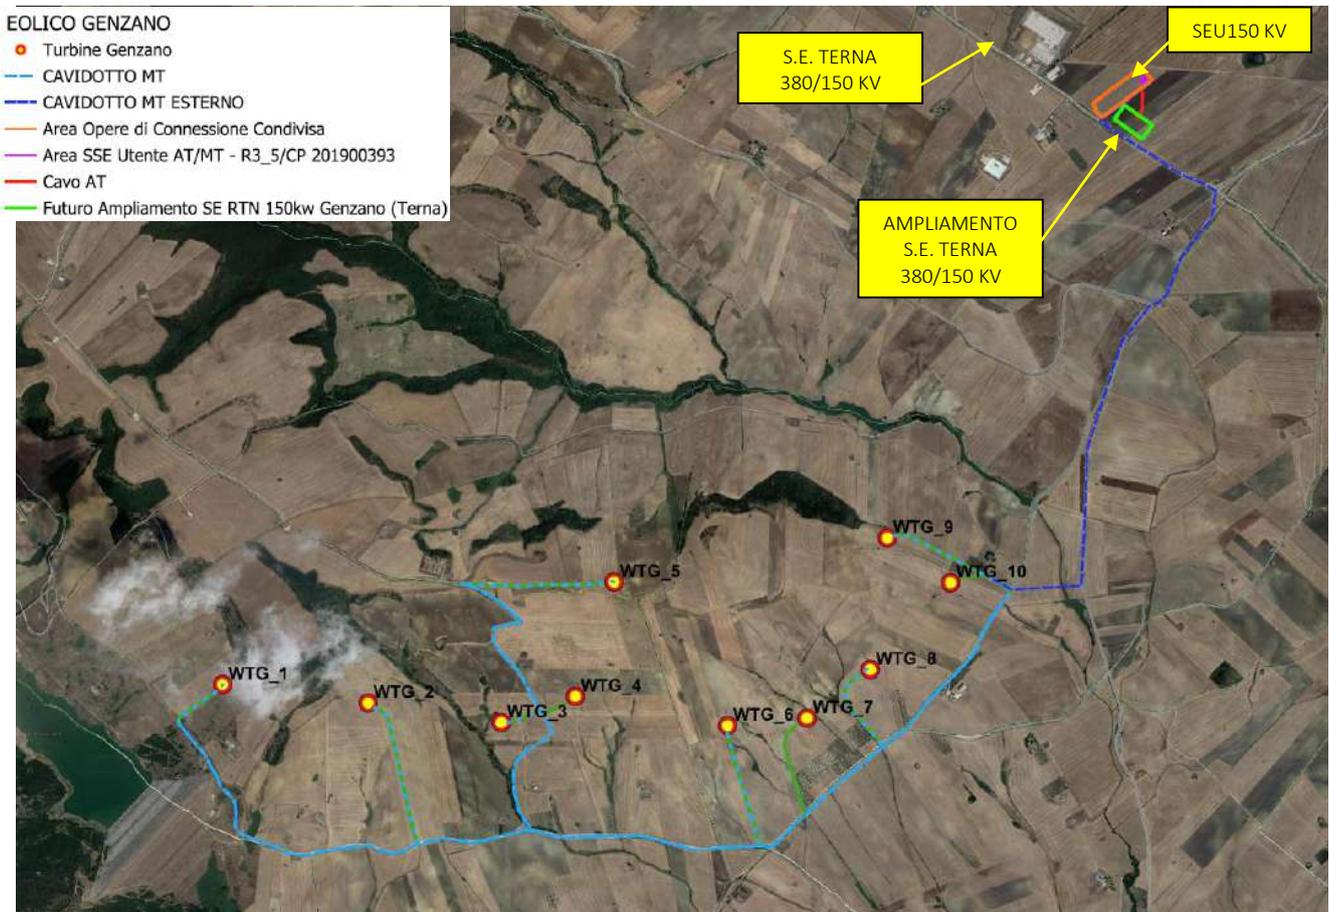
Area di intervento: dettaglio layout di progetto su ortofoto
